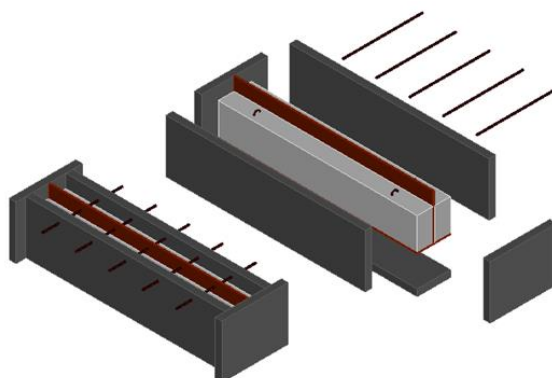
Esquema da cofragem das vigas em CAD®
